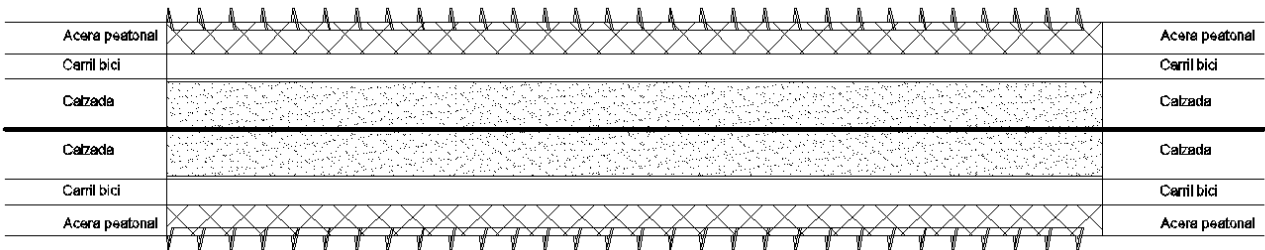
Figura VIII: PLANTA DEL PUENTE VIGA DE HORMIGÓN
